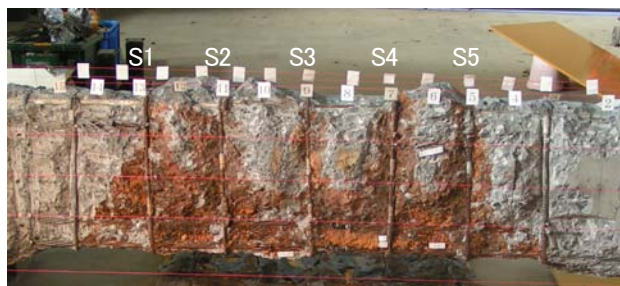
かぶりコンクリート撤去状況 (No. 1、A 面左)
